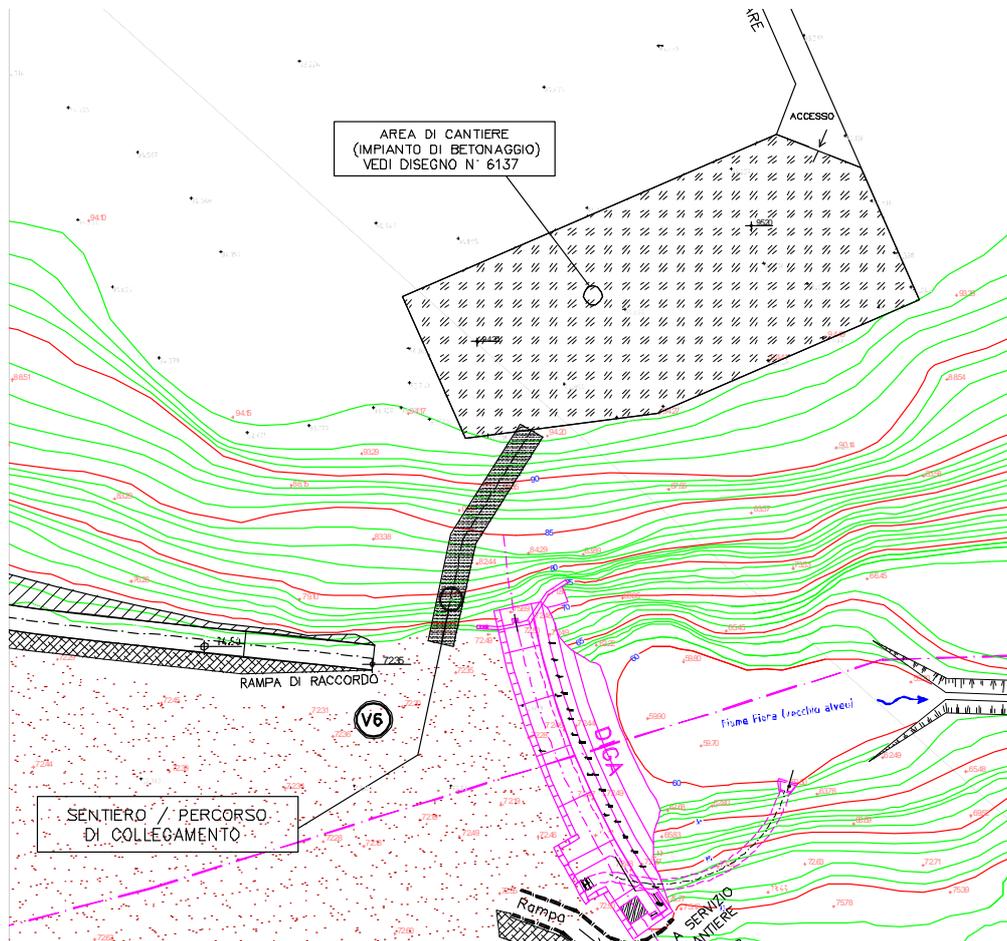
Localizzazione dell’area di cantiere in sponda sinistra
